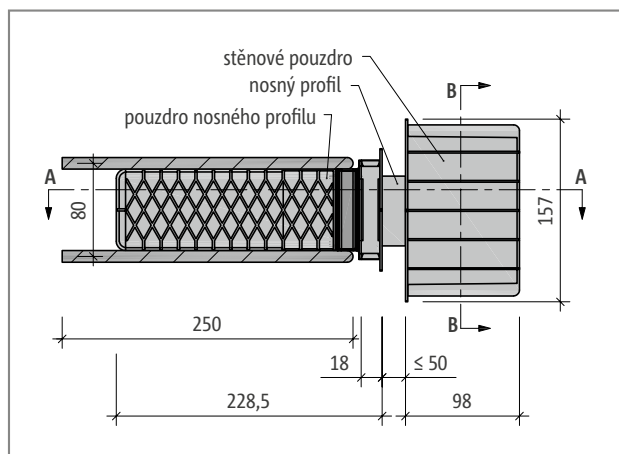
Schöck Tronsole® typ Q: Uspořádání prvků – detail B
